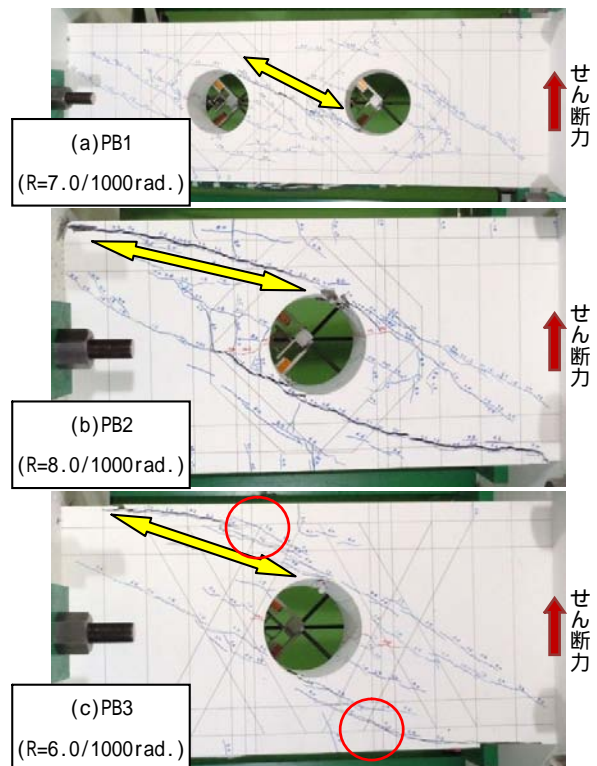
最大耐力直後のひび割れ発生状況
